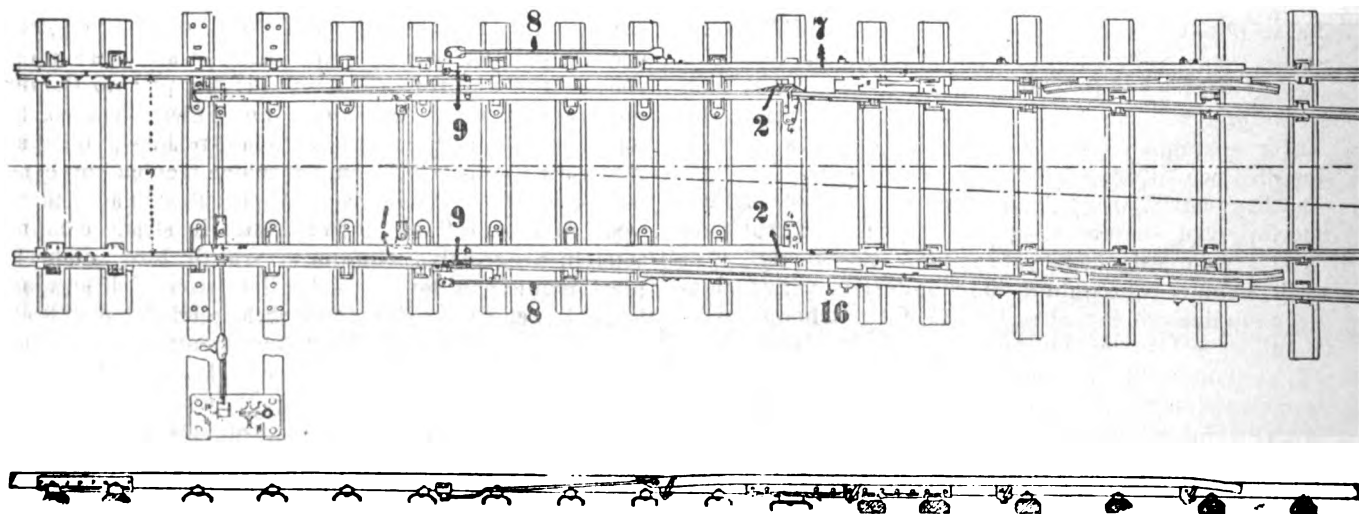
o 2. — Scambio di sicurezza Schilhan - Pianta ed elevazione.
